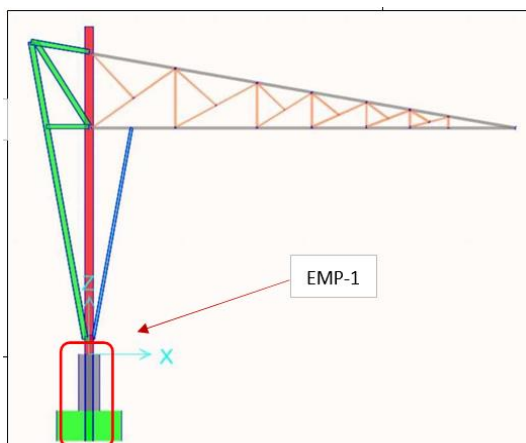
Vista de elevación en X del empotramiento - 1. Fuente: Solpesa SAC. (2023).
